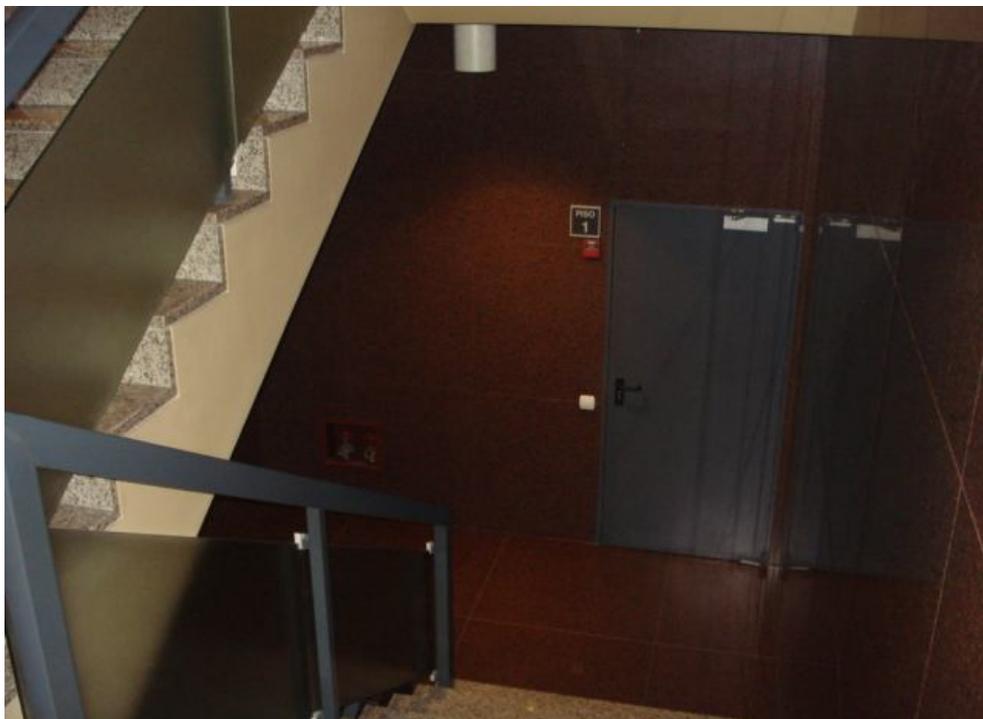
Porta de ligação caixa de escada / 1º piso (caixa de escada do lado sul).
